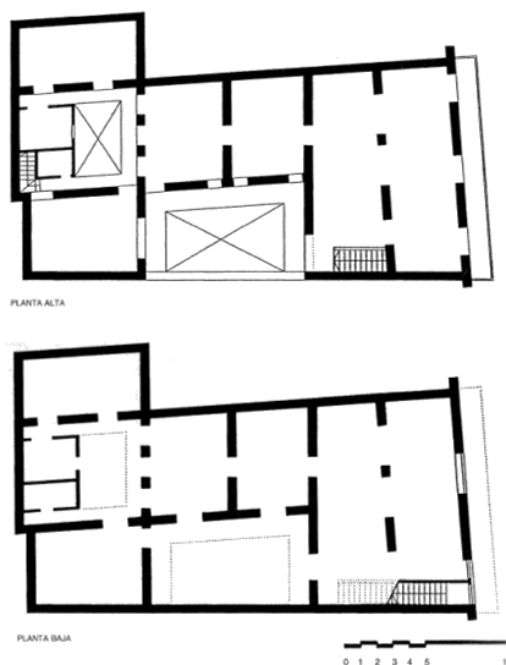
Planta alta y planta baja, casa de altos en Cuba. Fuente: Libro La Casa Meridional.
